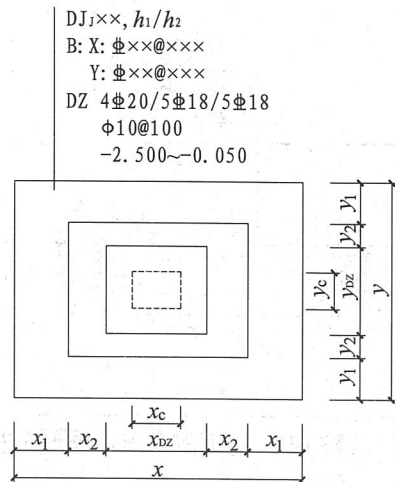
普通独立基础平面注写方式设计表达示意
